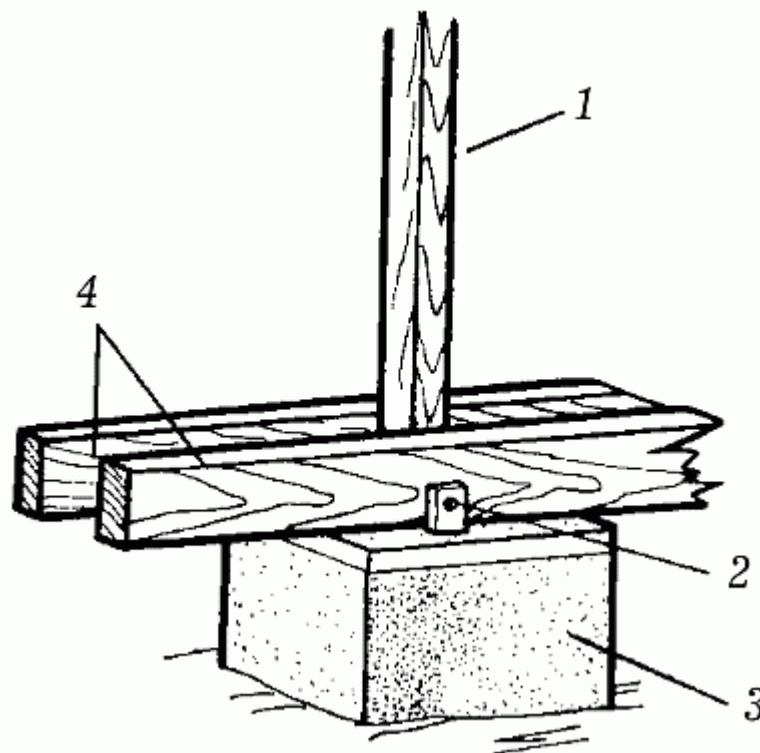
Столбчатый фундамент: 1 – стойка; 2 – анкер; 3 – столб; 4 – лаги
